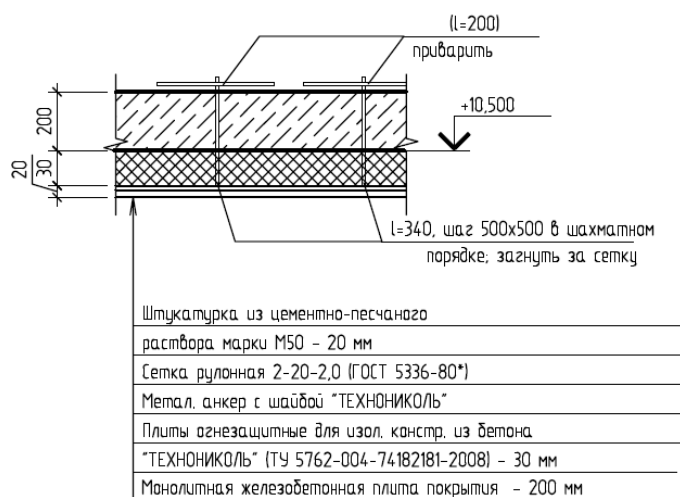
Схема детали огнезащиты перекрытия лестничной клетки
